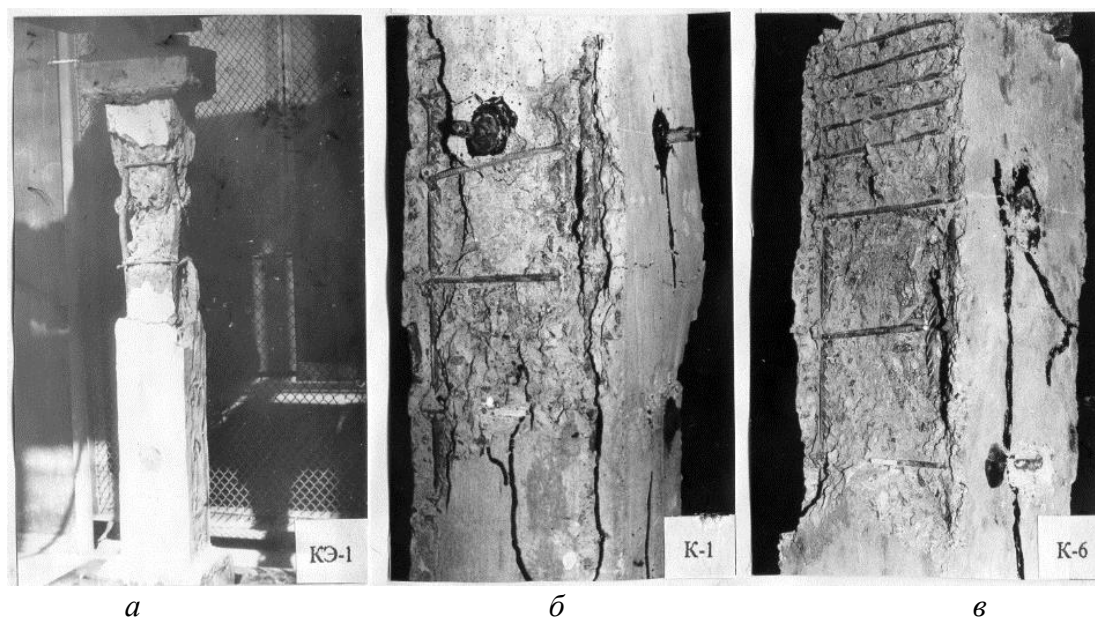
Общий вид разрушения опытных железобетонных элементов
